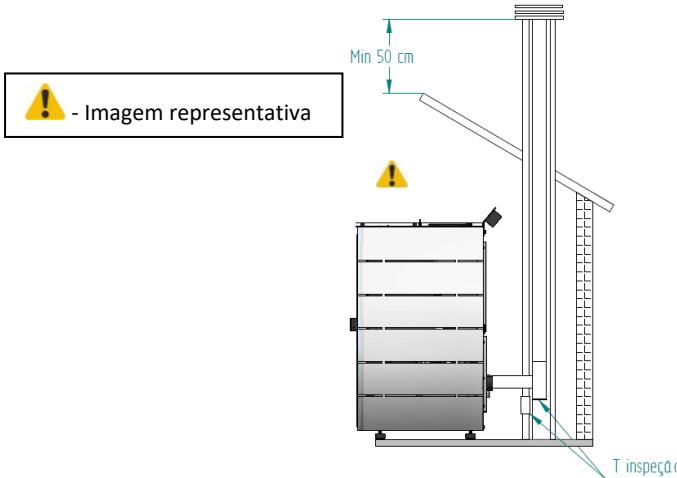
Vista lateral do sistema com chaminé, com exemplo do ponto de inspeção
